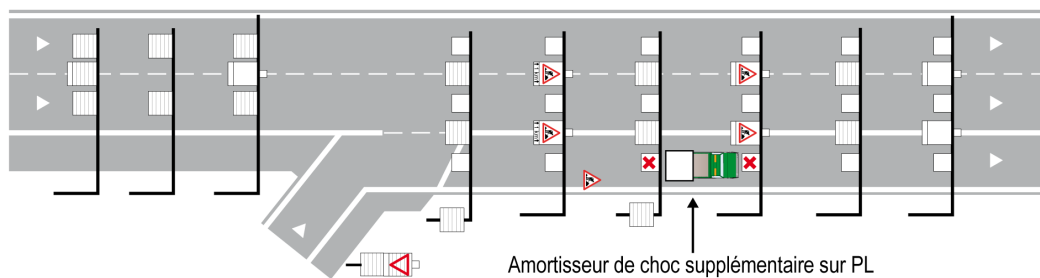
33.4 BAU fermée : exploitation de la BAU lors de travaux d'entretien.
